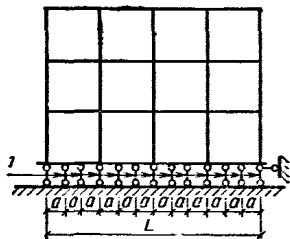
Расчетная схема каркаса на ленточных фундаментах
